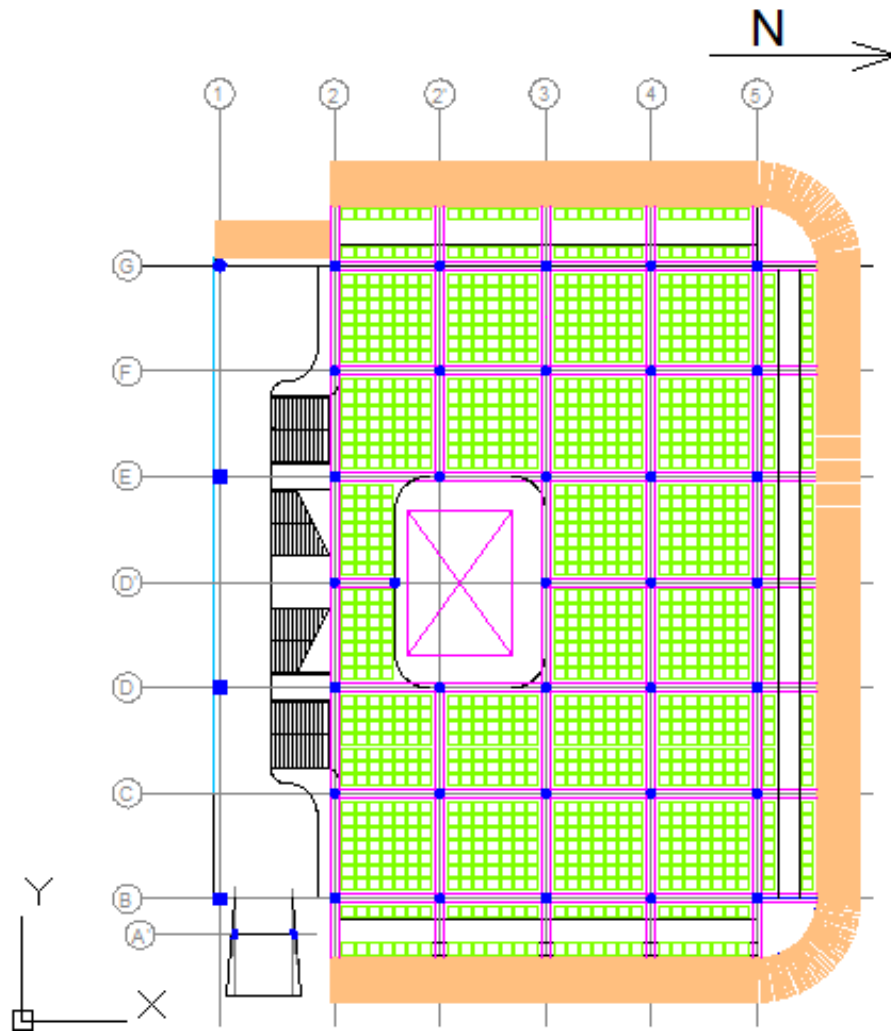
Croquis edificio de Ampliación del Comedor. Planta tipo.
